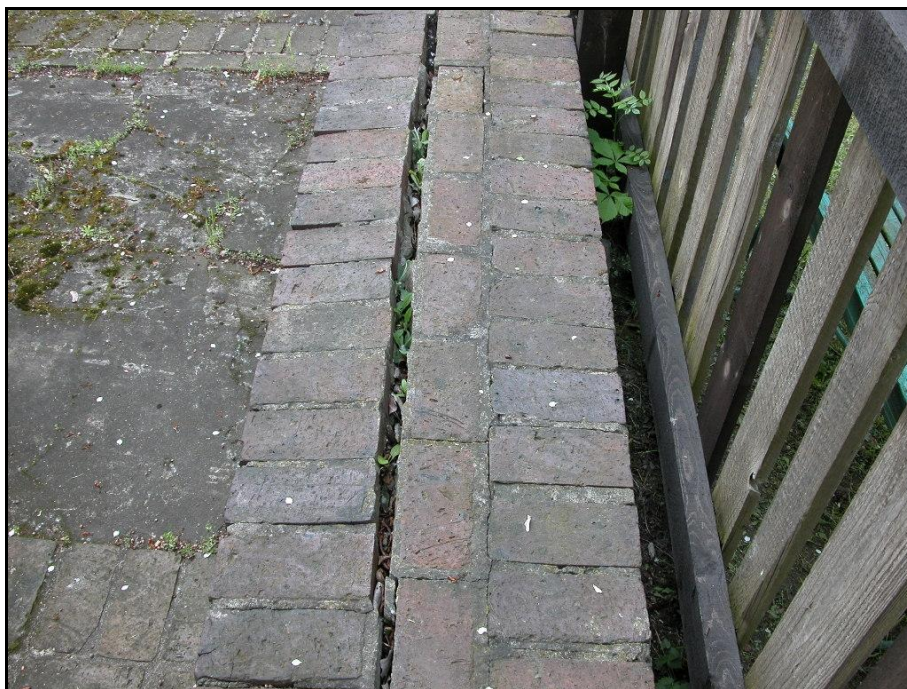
Murek obrazujący przebieg starych fundamentów kuźni, murek oraz beton w złym stanie technicznym
